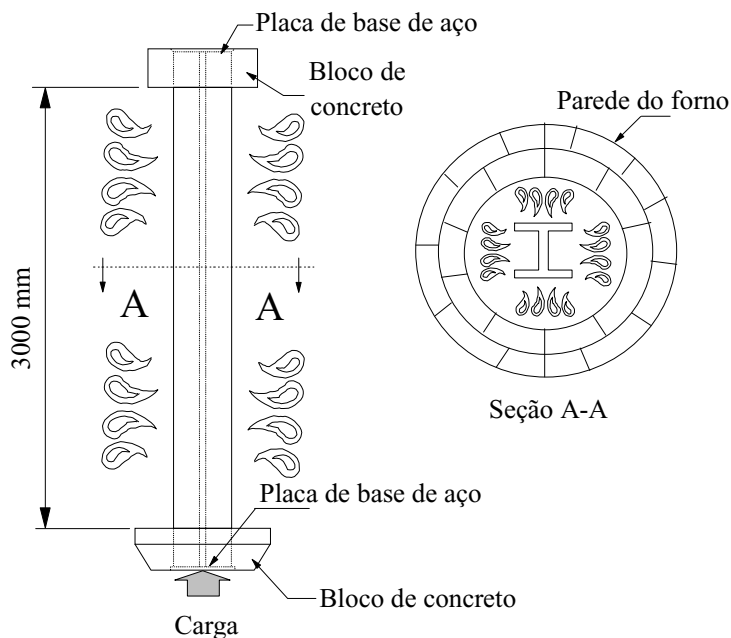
Detalhes do ensaio de Incêndio Padrão em pilares
